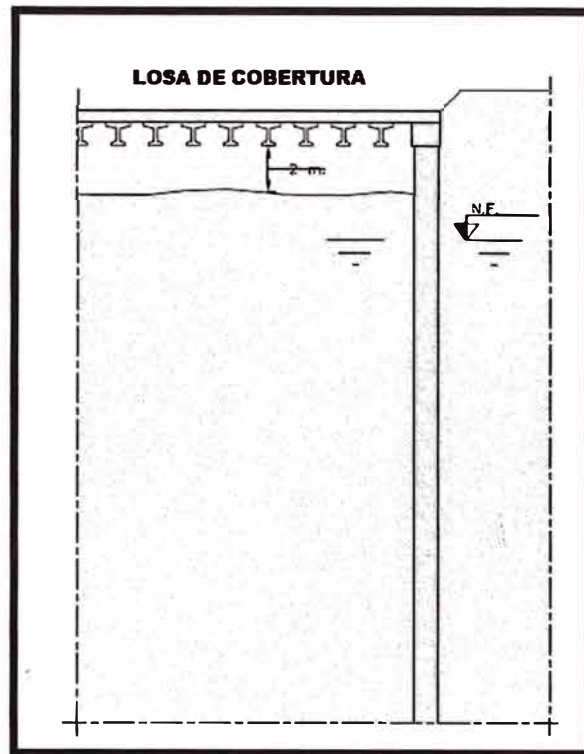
Losa de Cobertura con vigas prefabricadas.
